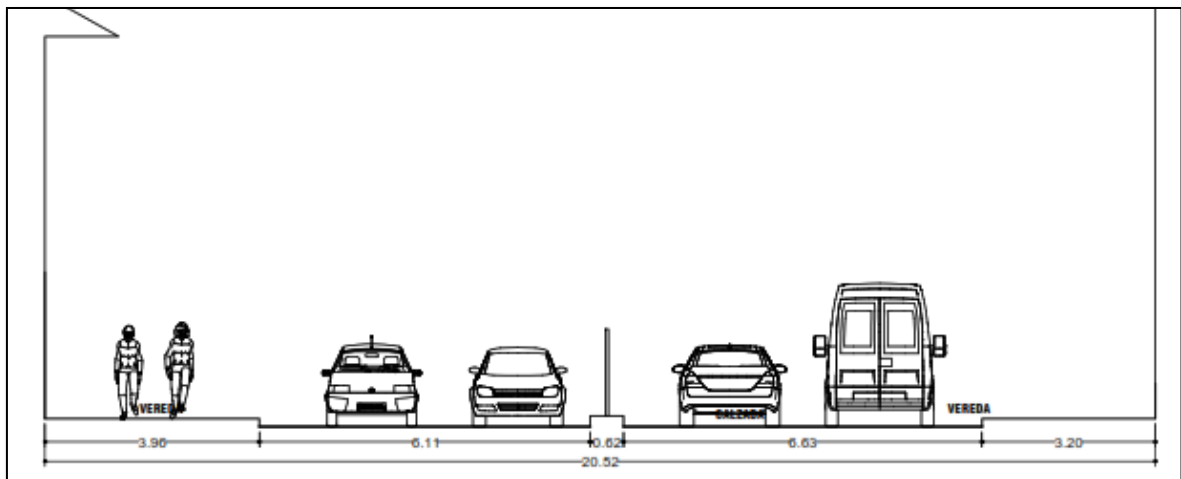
Av. Garcilaso situación actual, Corte 16-16
